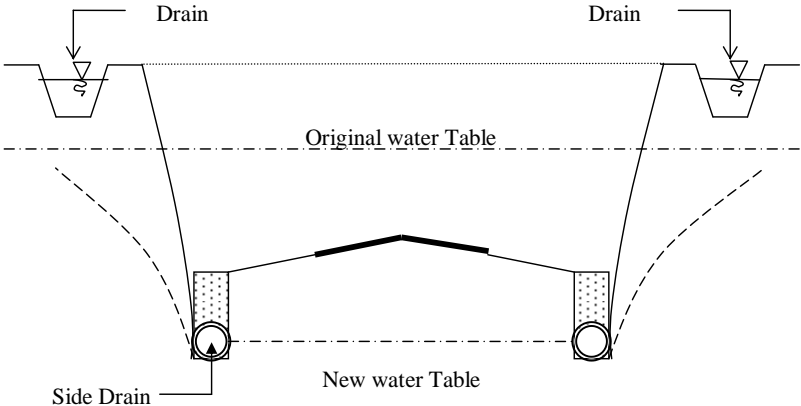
Denah System of LATERAL & LONGITUDINAL DRAINS
